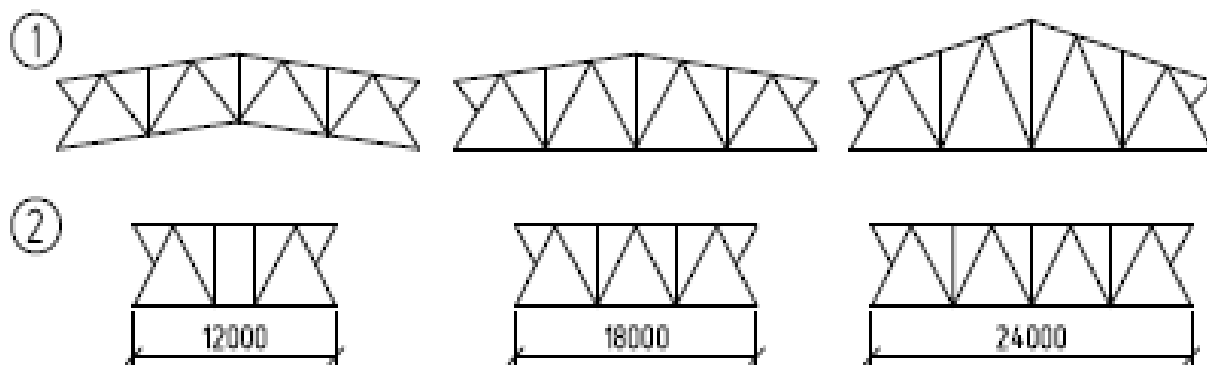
Стальные стропильные (1) и подстропильные (2) фермы
